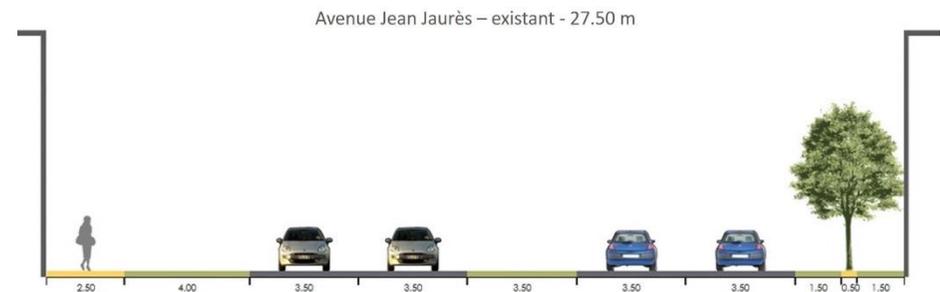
Coupe 4-1 actuelle – avenue Jean Jaurès
